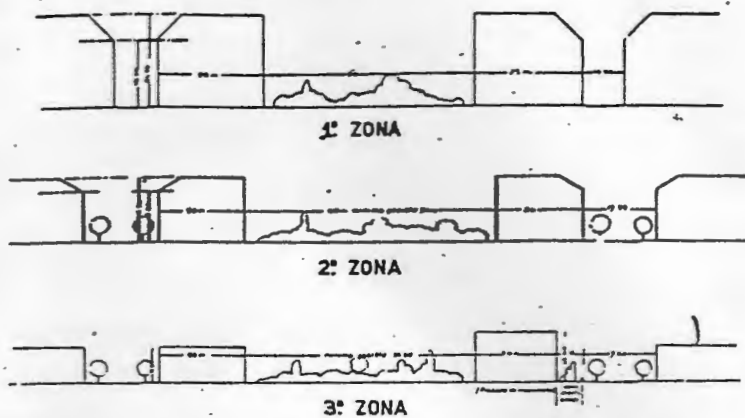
/ A la derecha / Secciones transversales para alturas generales de edificación / No se podrá construir en los centros de manzanas, excepto en el subsuelo y planta baja de la 1ª zona
